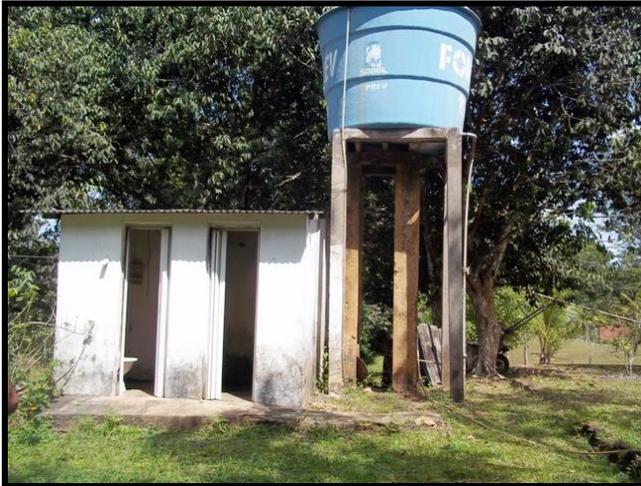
Poço com caixa d'água ao lado de Banheiros.
